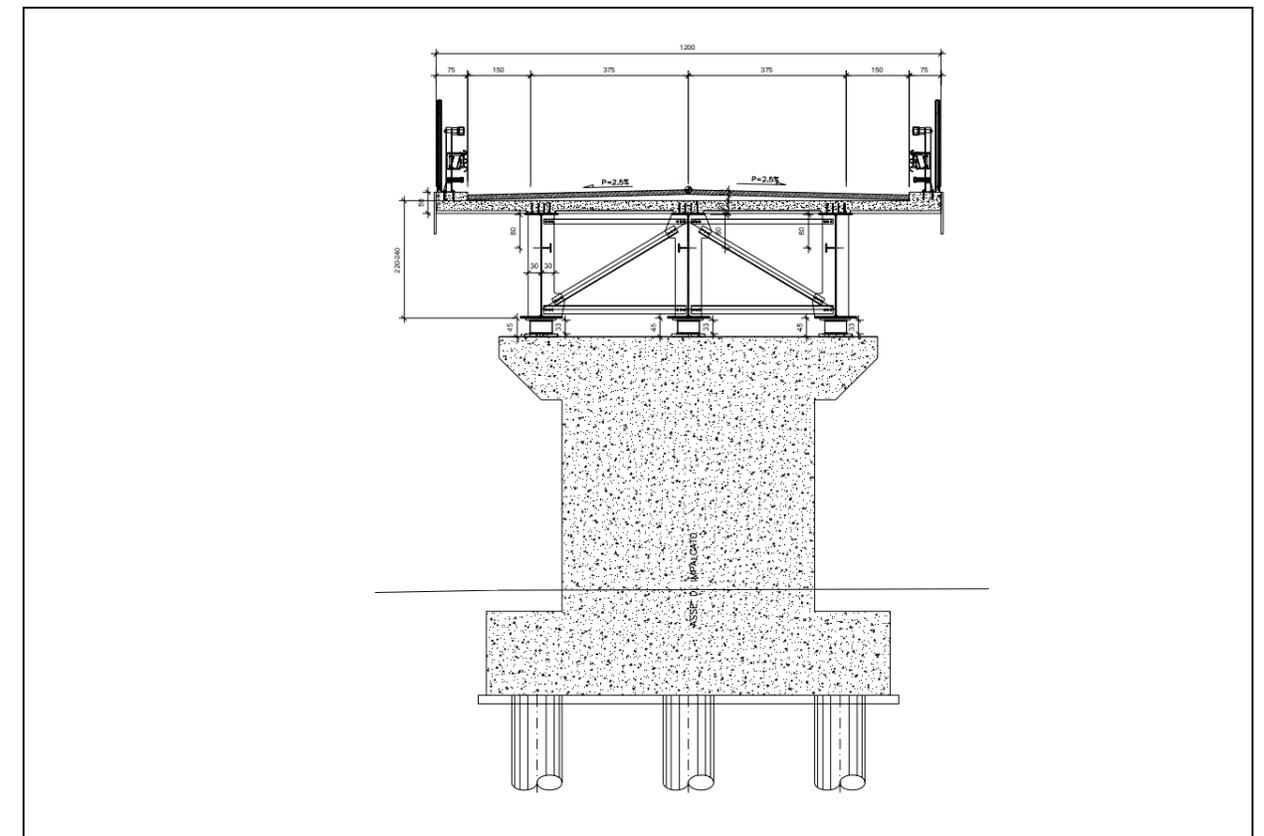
Viadotto di progetto: Sezione trasversale dell'impalcato
